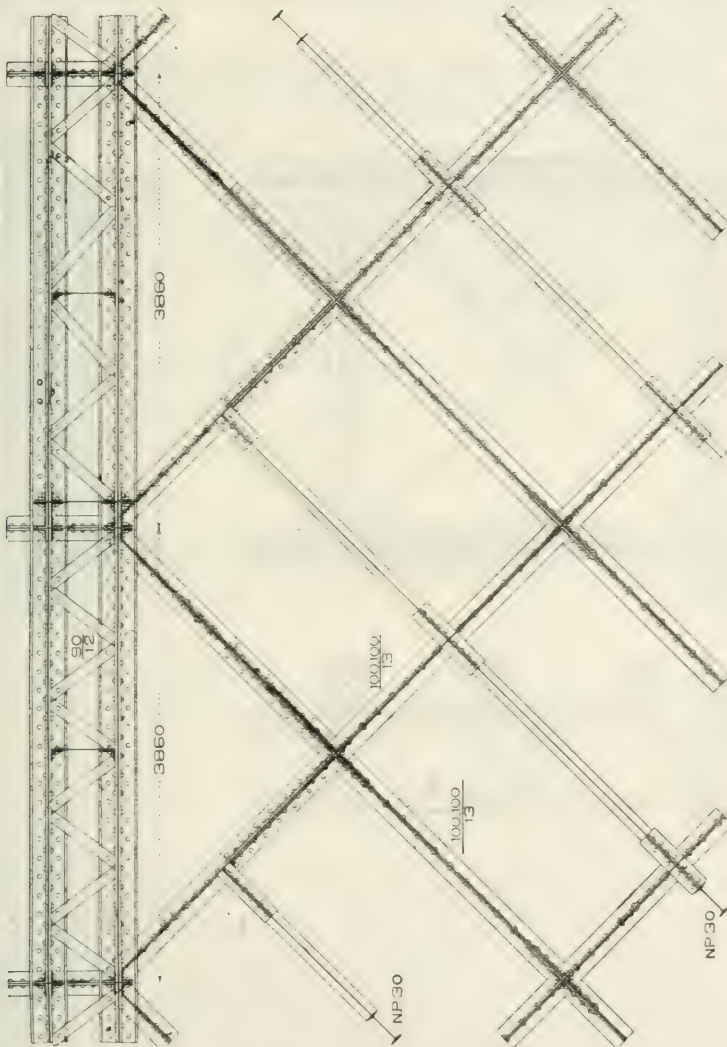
Fahrbahnträger der Elbebrücke bei Loschwitz. Grundriß.
